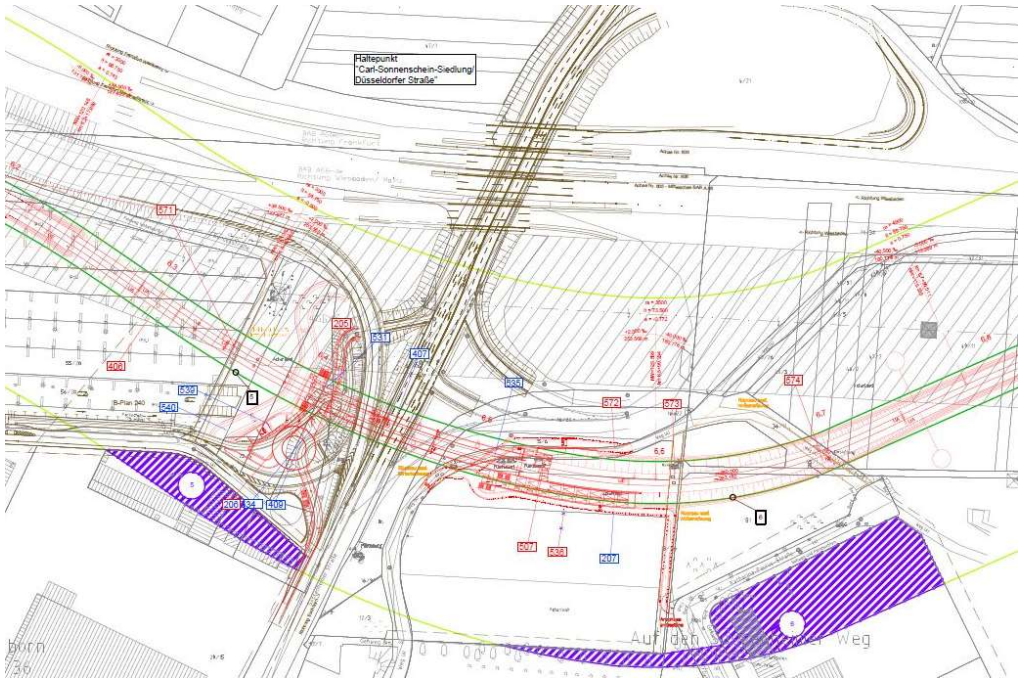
Planausschnitt Eschborn Schwalbach mit Bereichen der maßgeblichen Minimierungsorte
